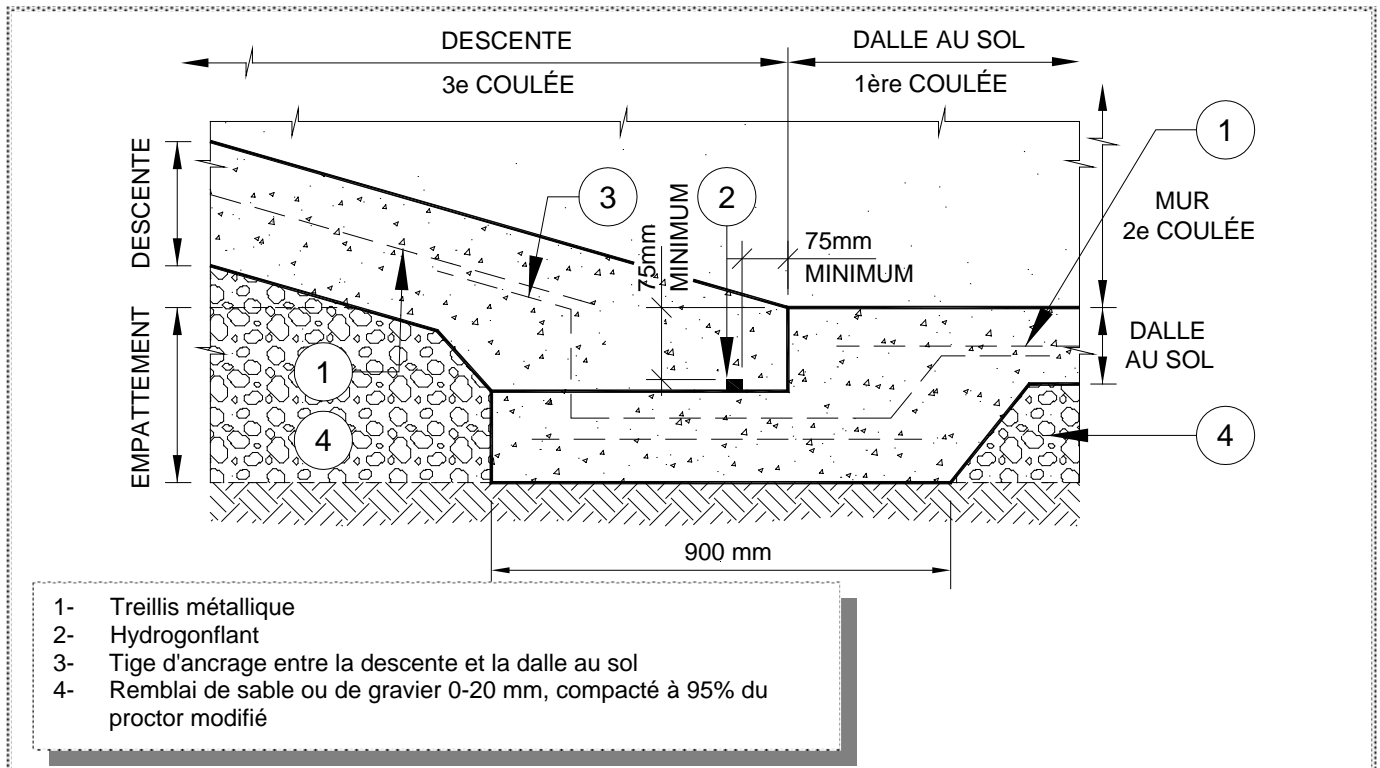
Étanchéité entre la dalle et la descente (Joint de construction)
